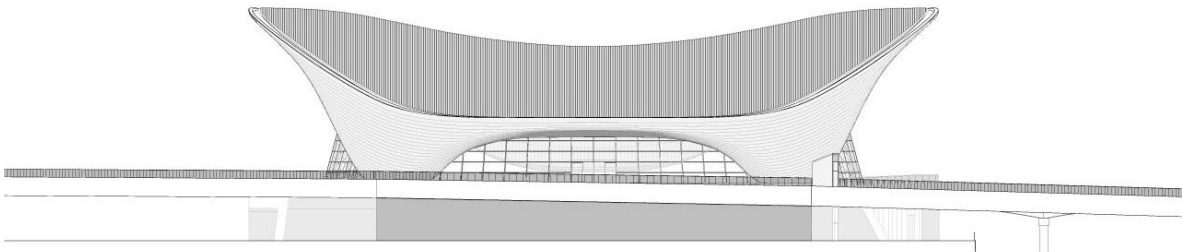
Corte Longitudinal, Complejo acuático de Londres. Fuente Archdaily.
